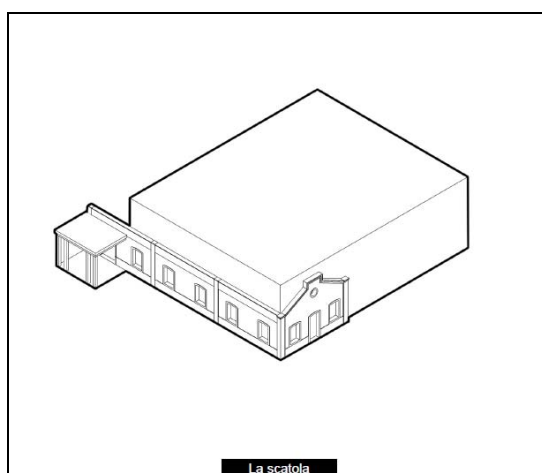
Prospetti e planimetrie indicative dell'idea progettuale
